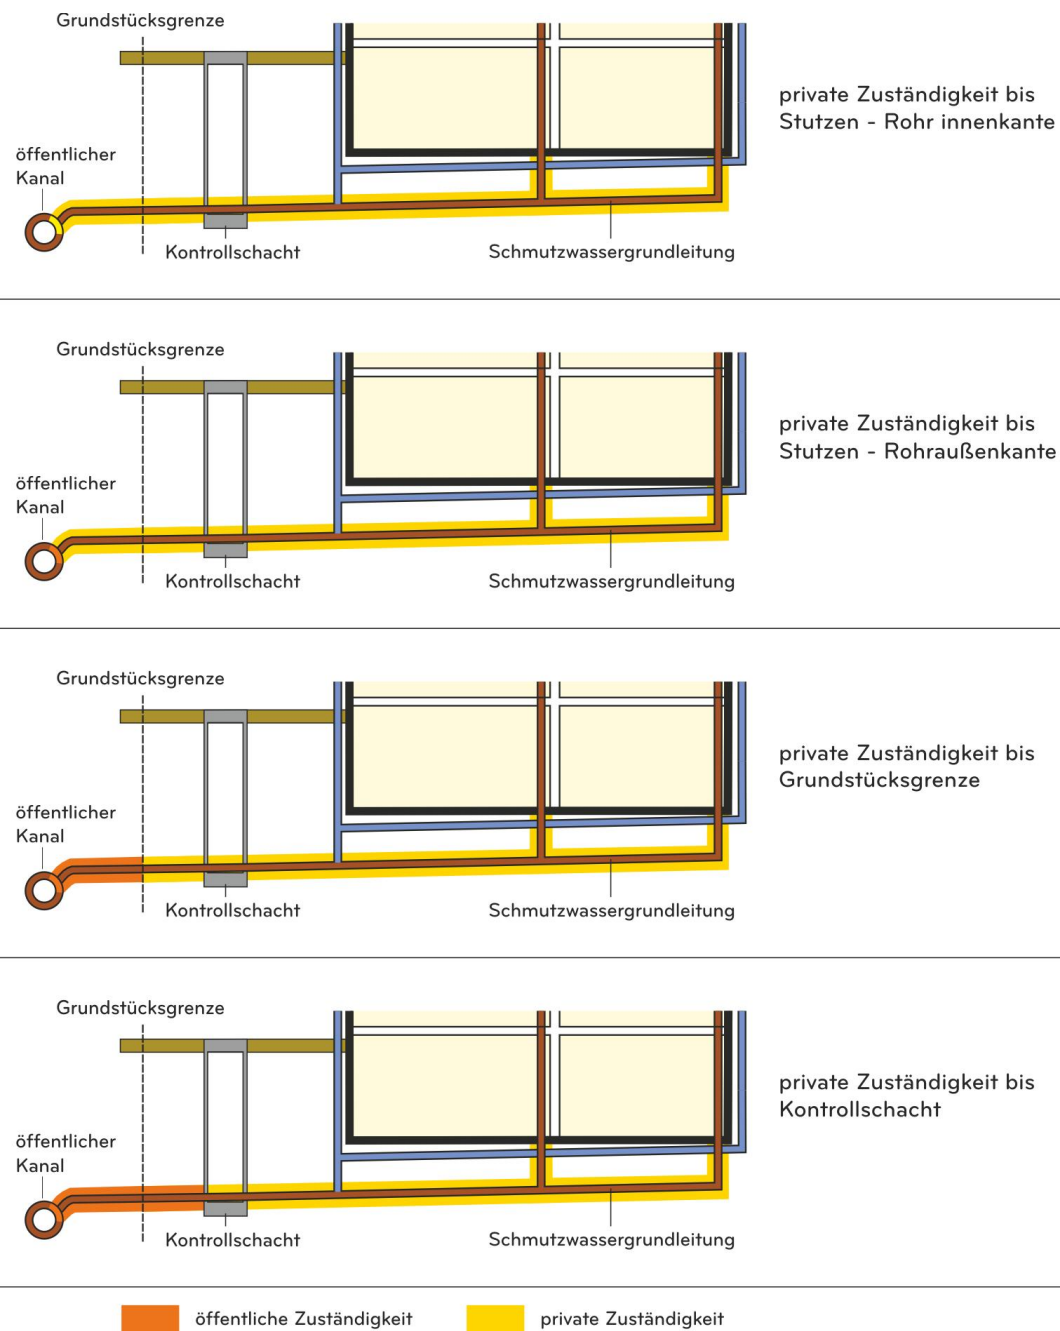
Anschlussbereich mit den vier wesentlichen Varianten
